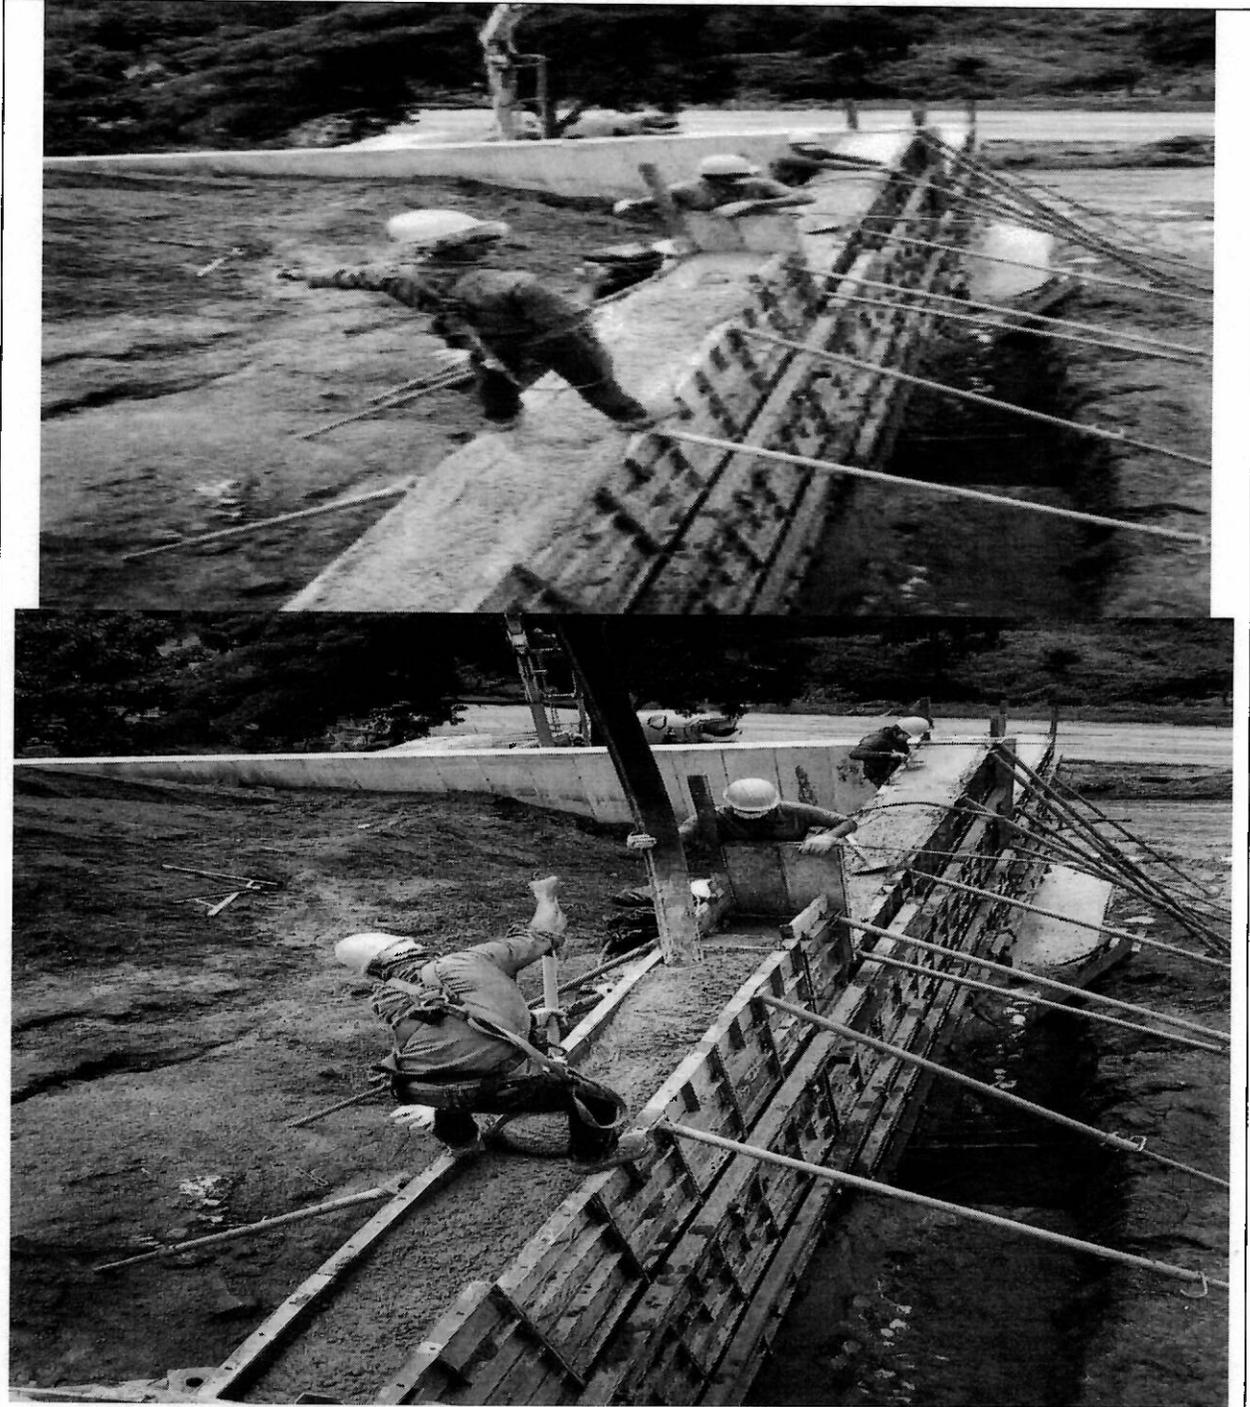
COLOCACIÓN SE CONCRETO 4000PSI PARA MURO
